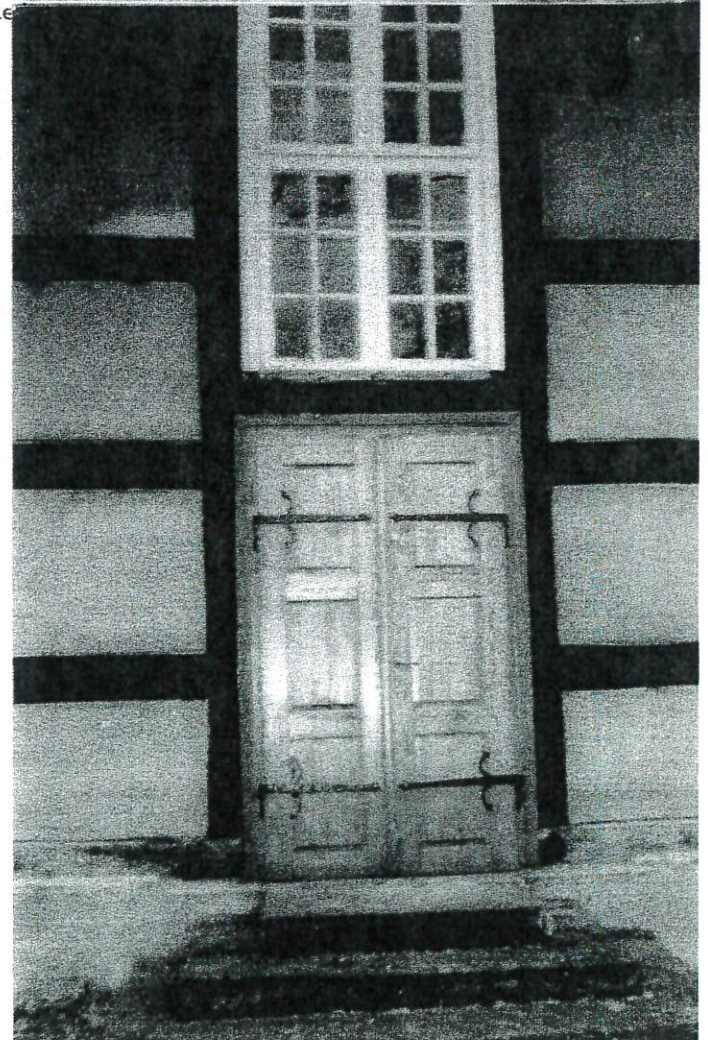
strefa południowa zabudowy budynku Kościoła, część cokołowa, schody betonowe
